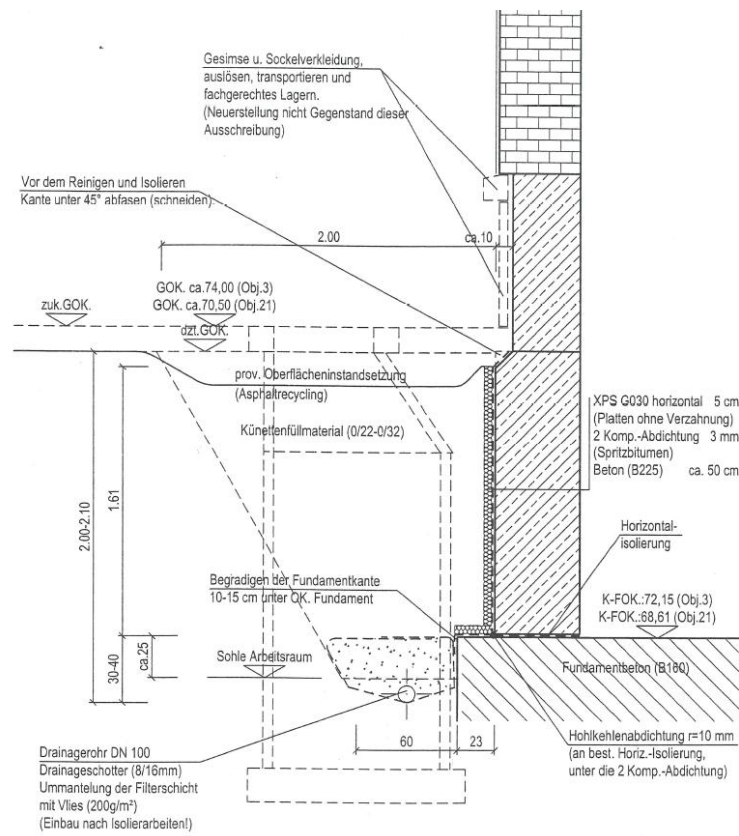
Schnitt-Detailausführung - hofseitige Drainagierung, Abdichtung und Dämmung des Kellermauerwerk [17]
